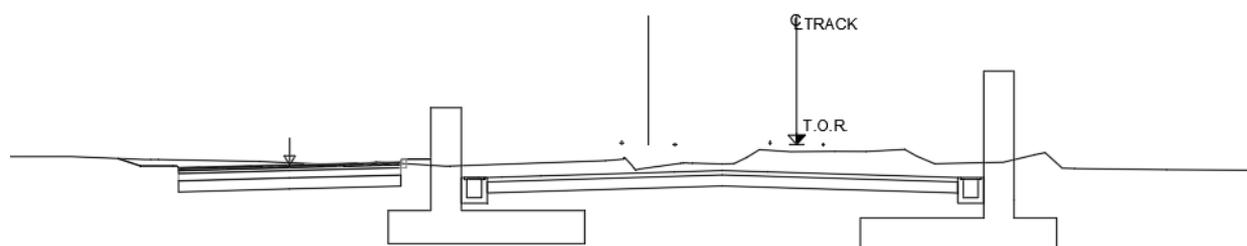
Sezione tipo situazione di progetto Via Vibrata
